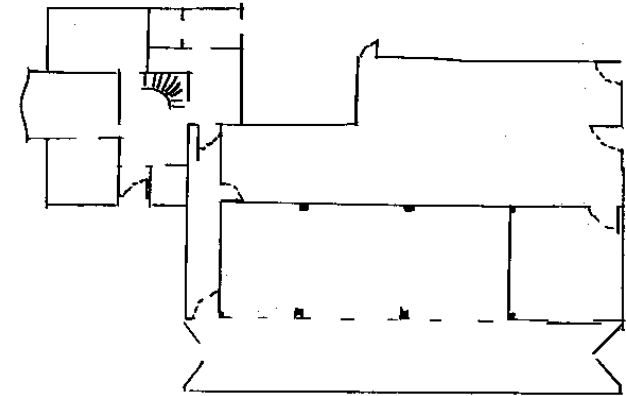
und 7 Grundriss und Hofgebäude Johann Hinrich Geerkens
